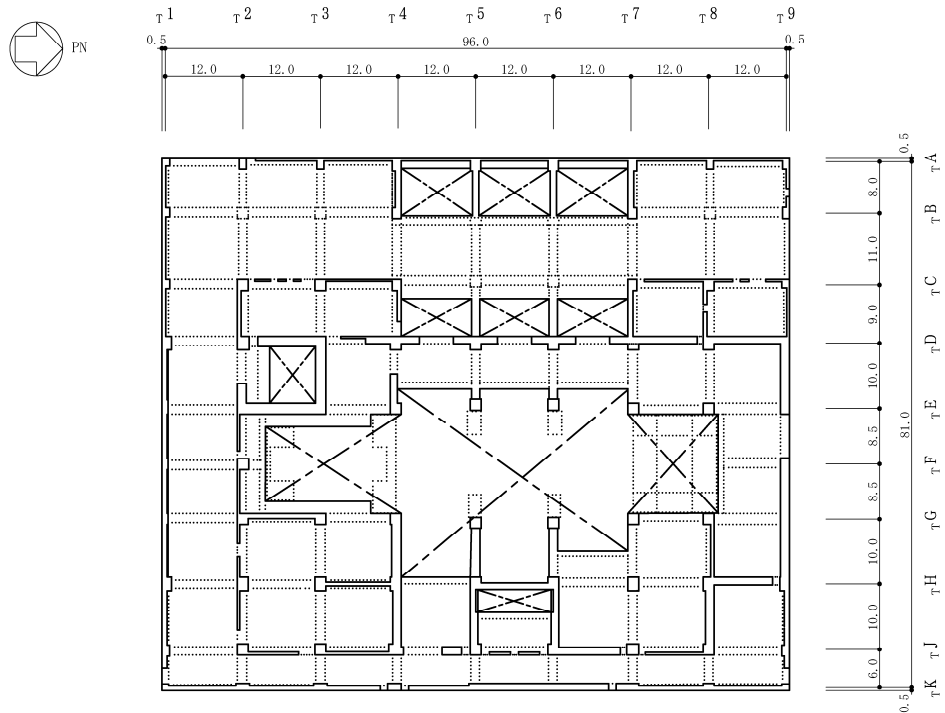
タービン建屋の概略平面図 (1F, T.M.S.L. 12.3m) (3/6) (単位 : m)
